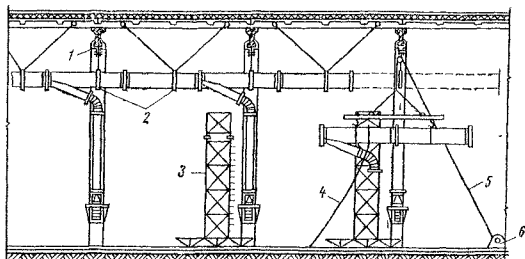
Монтаж воздуховодов с помощью барабанной лебедки и крепежные их к строительным конструкциям
